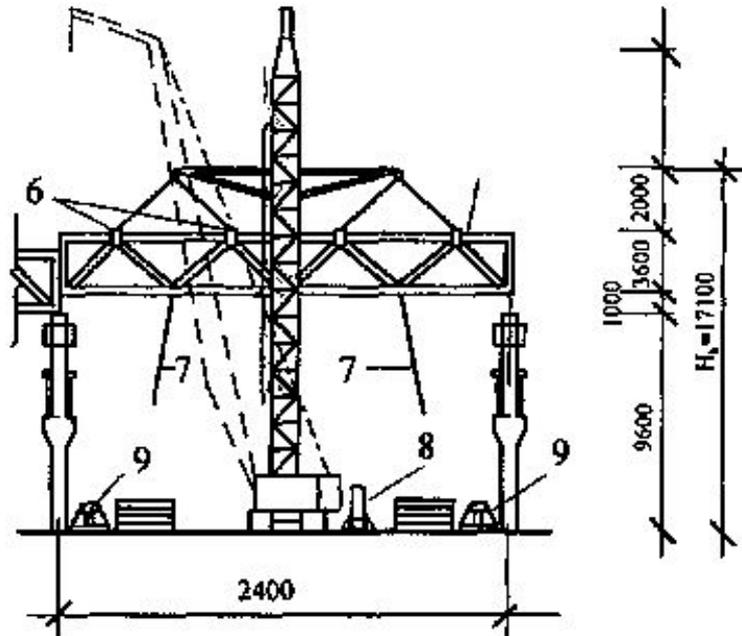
Схема раскладки и монтажа элементов покрытия одноэтажных промышленных зданий:
